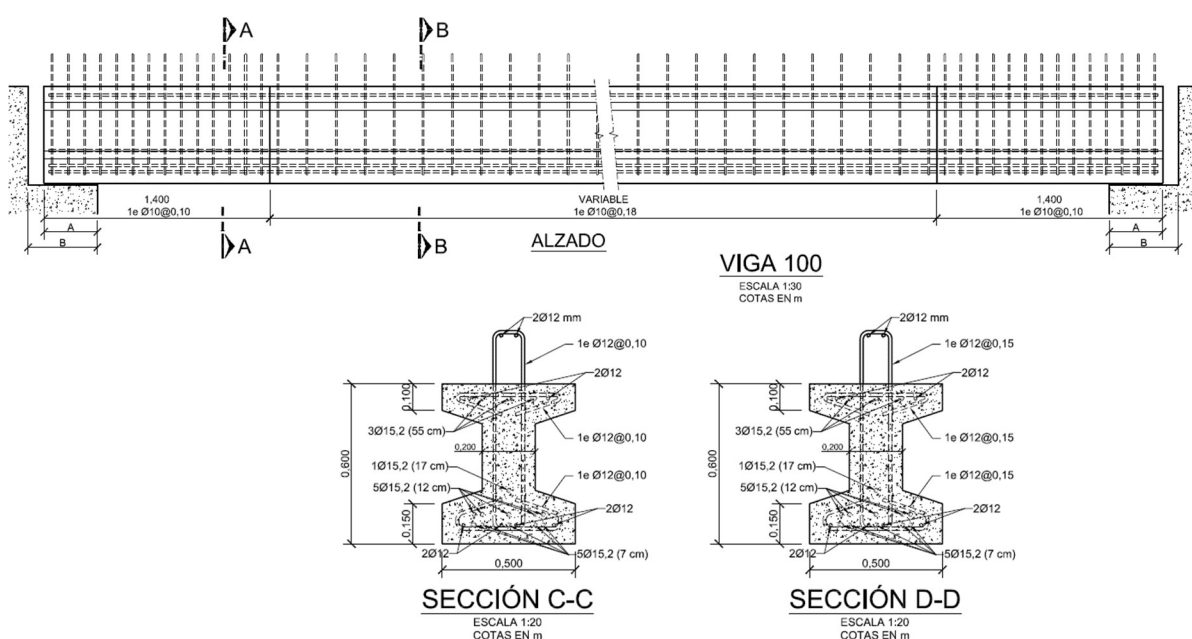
Situación Proyecto Original. Geometría y armado. V1-100. Fuente elaboración propia.
